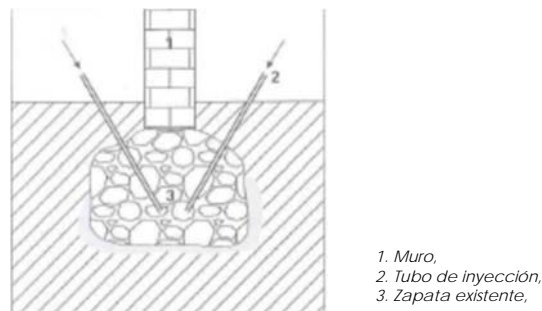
Inyección directa en cimentación de mampostería existente [1]
